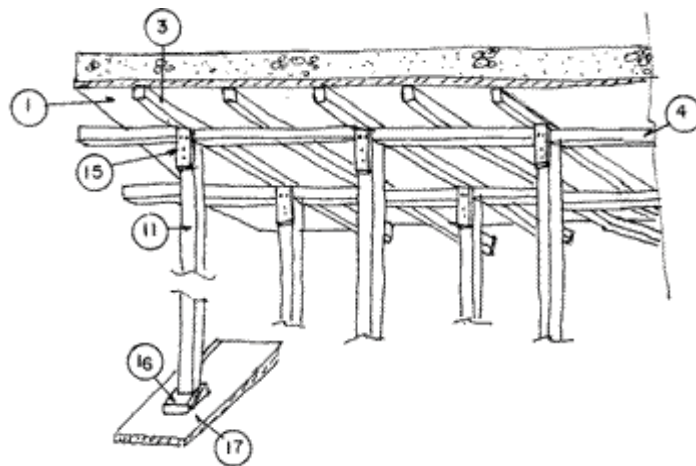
Esquema do processo executivo de lajes maciças – (MILITO 2004)
